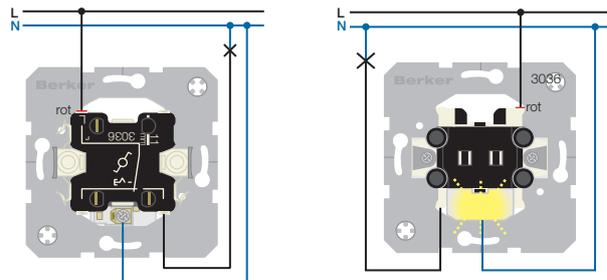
Beleuchtet bei EIN, Ausschaltung mit Wechselschalter (Kontaktzunge am Glimmaggregat entfernen)
